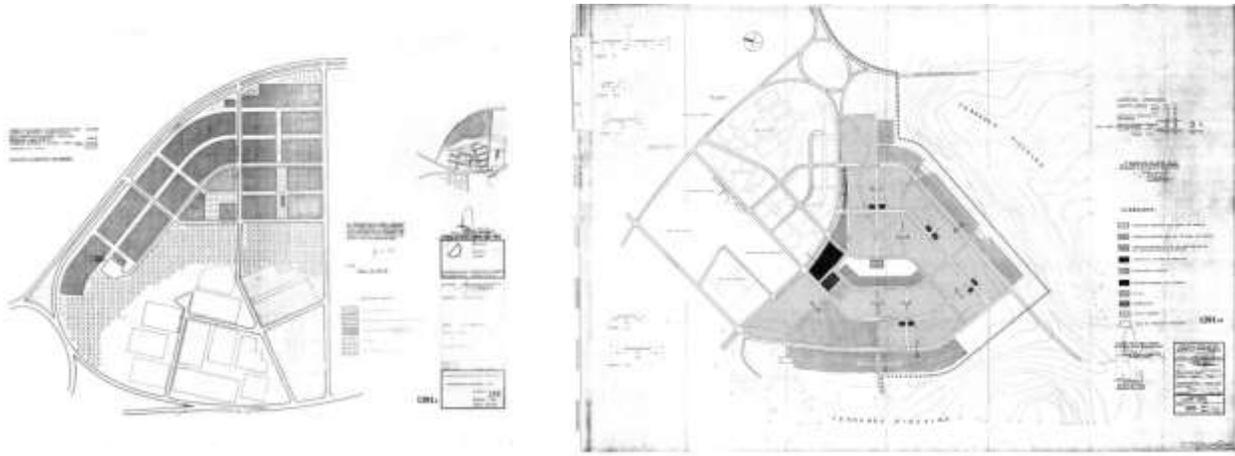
Plan Seccional Saucache Sur (CORMU, 1969) y Plan Seccional Pampa Nueva (CORMU, 1971)
